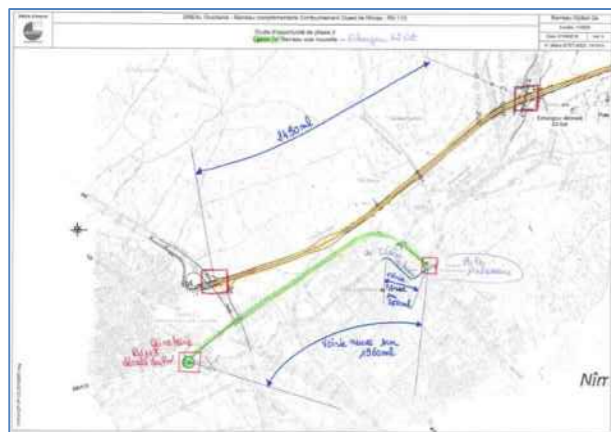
VE2Est-opt2 barreau voie nouvelle
